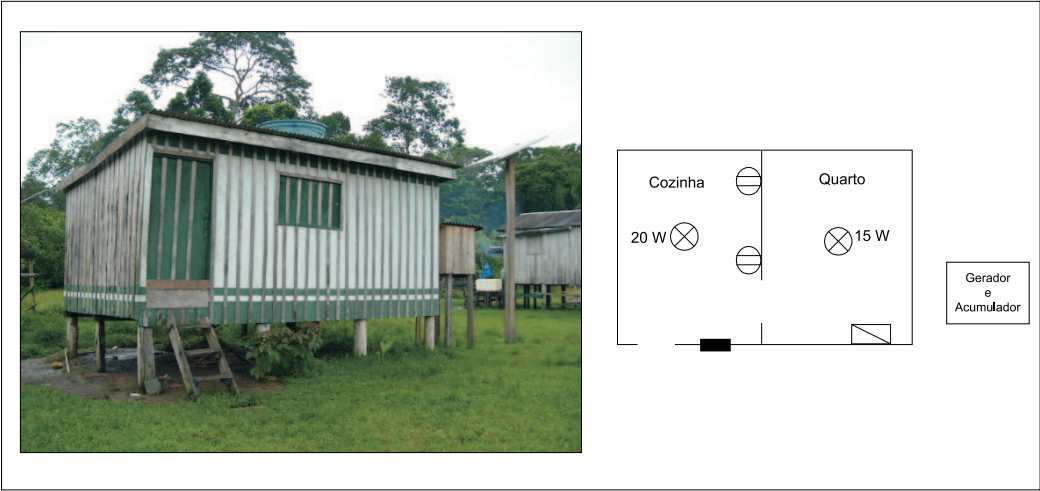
Vista externa do SFD13 e planta aproximada do domicílio.
